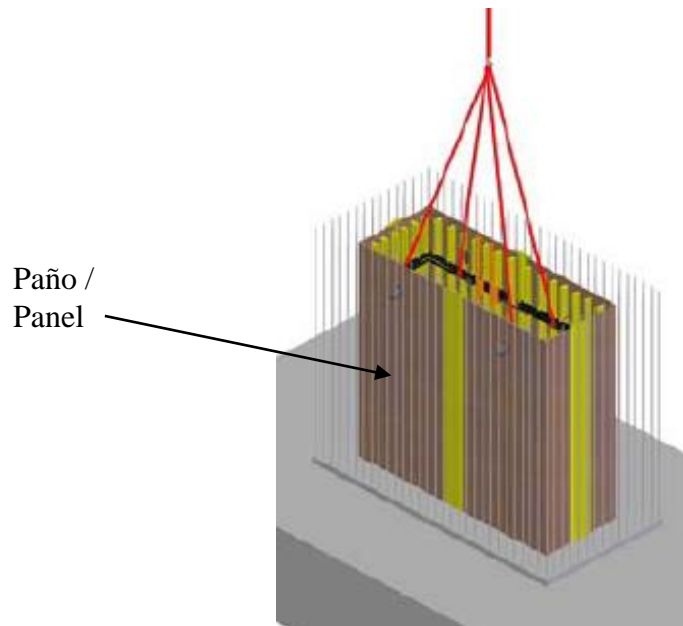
g. Colocación de paneles interiores. Adaptada de: Ulma Construction, *Instrucción técnica de montaje*.
